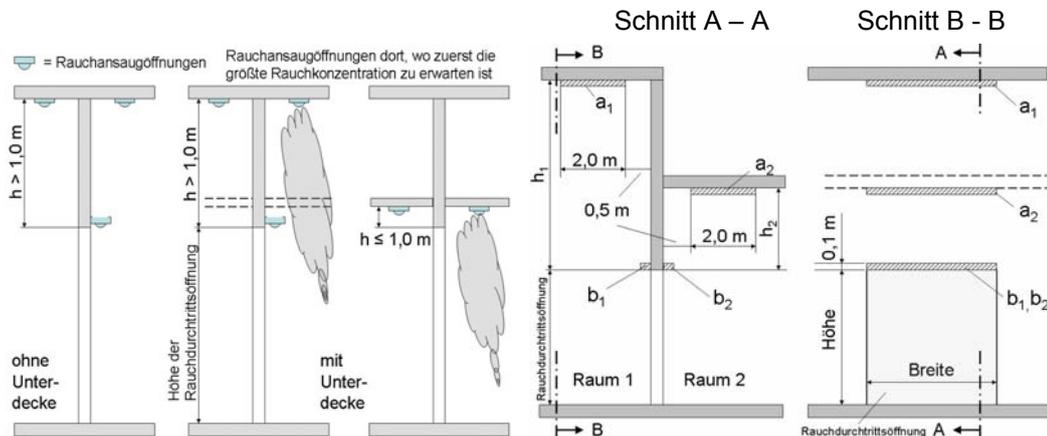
Maßgebende Höhe der Deckenunterfläche      Bild 2: Installationsbereiche
